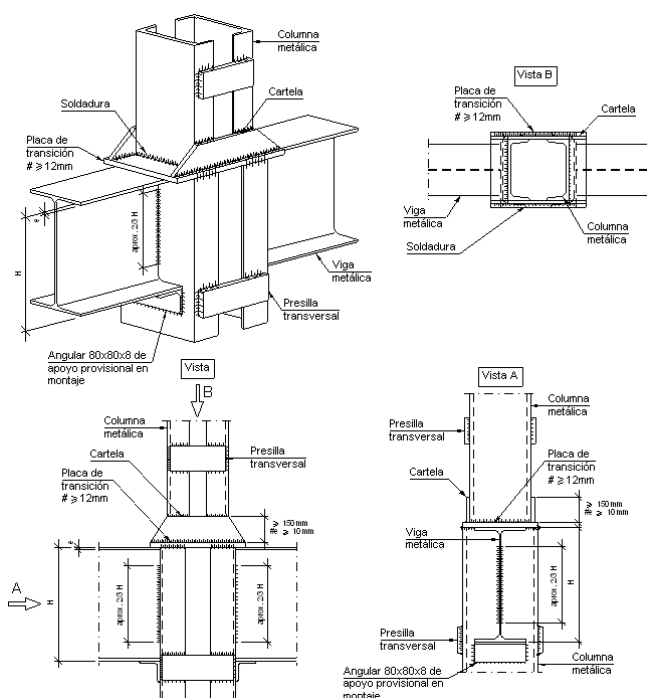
Archivos Planeación Municipal de Honda Tolima (2019) Detalle estructura metálica.
